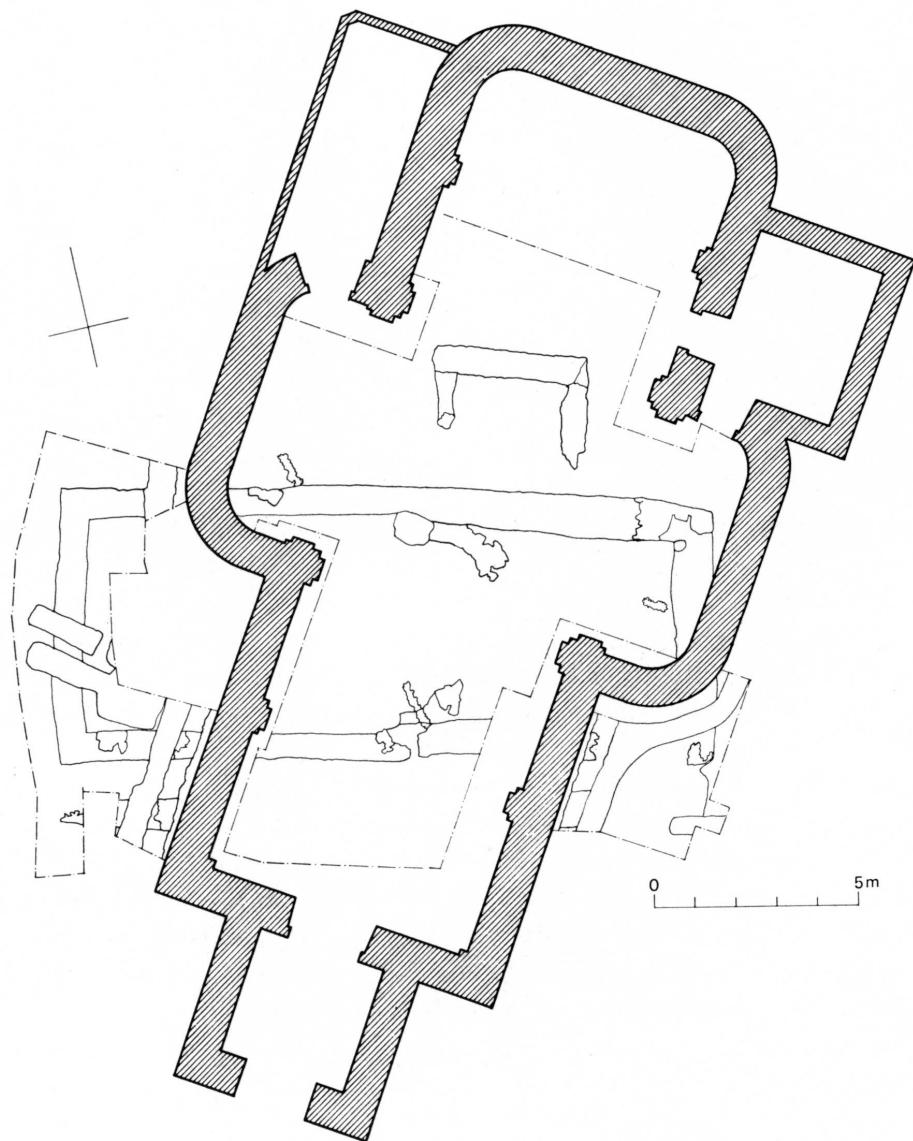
Eglise actuelle. Plan. Ech. 1: 200.
